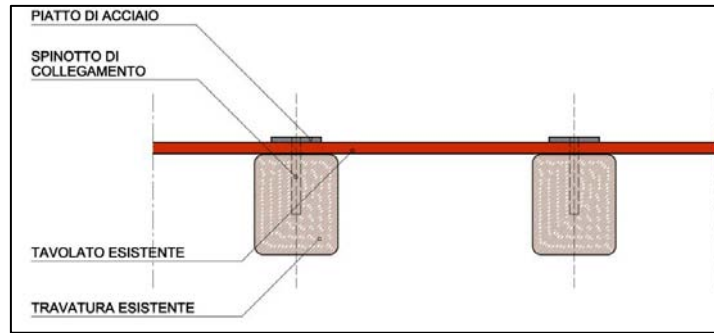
Sezione trasversale di solaio consolidato con profili metallici sottili
